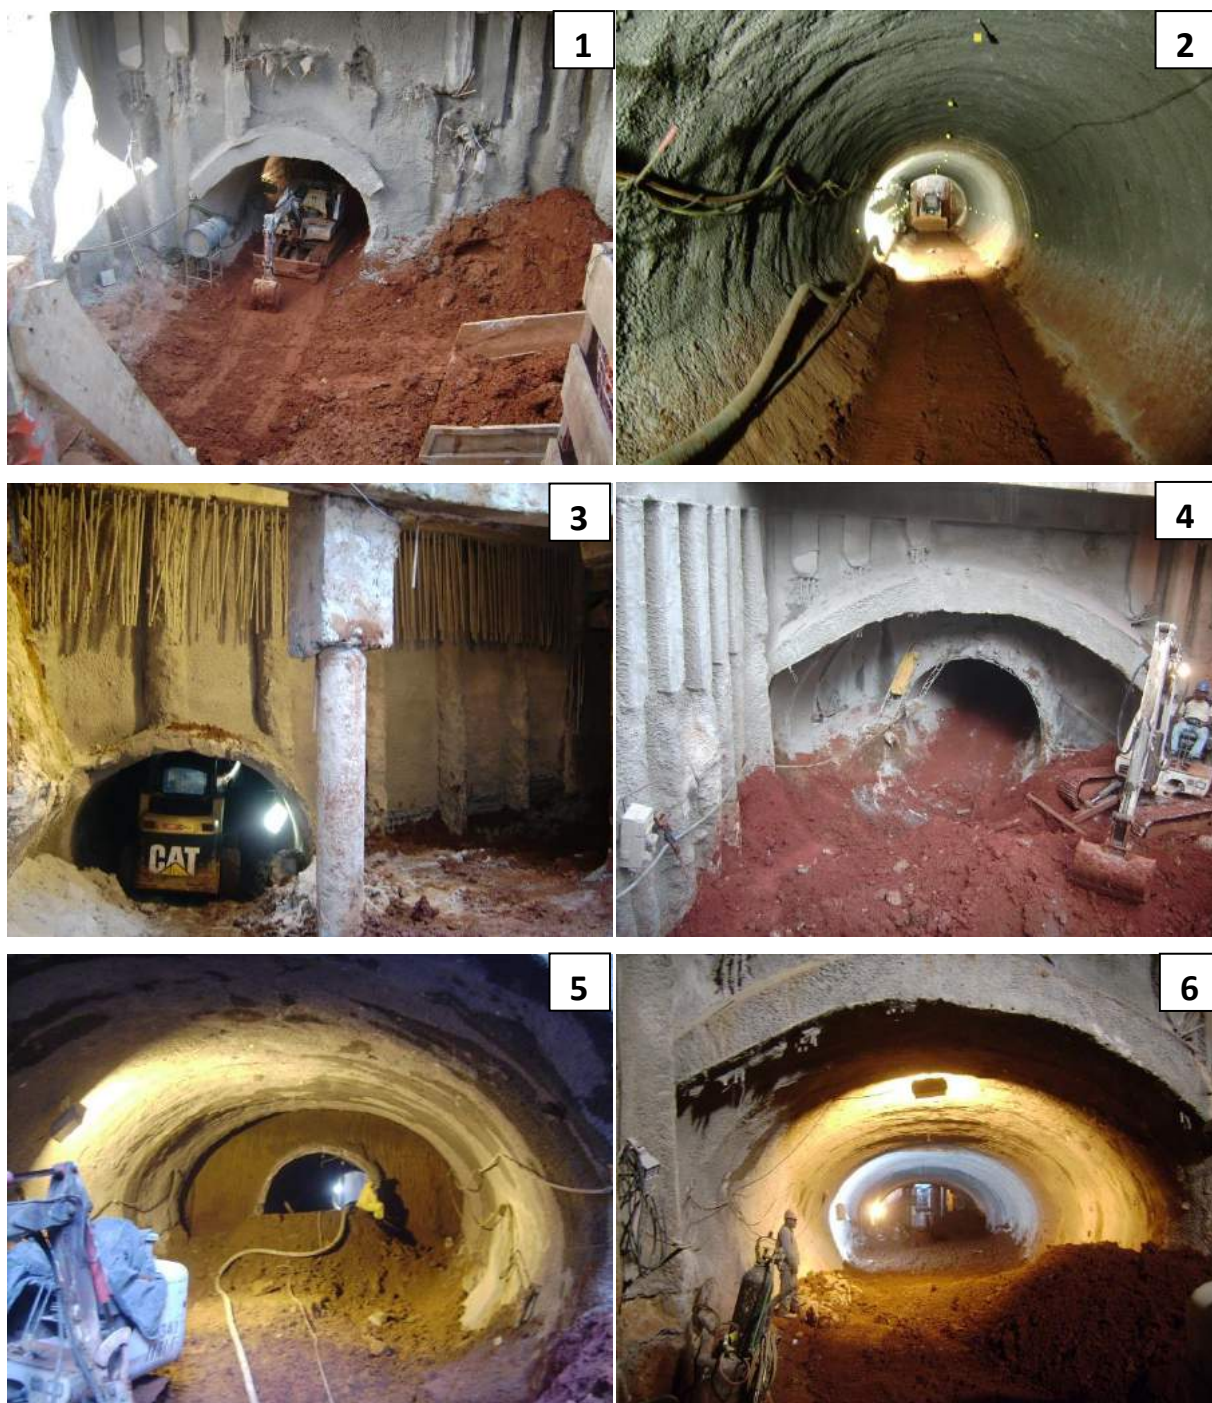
Fotografias das escavações: 1) Emboque do túnel piloto na VCA do acesso Angélica; 2) Vista interna do túnel piloto; 3) Desemboque do túnel piloto na VCA do acesso principal da estação; 4) Emboque da seção final na VCA; 5) Vista interna da escavação da seção final; 6) Escavação finalizada. Fonte: ATO [9].
